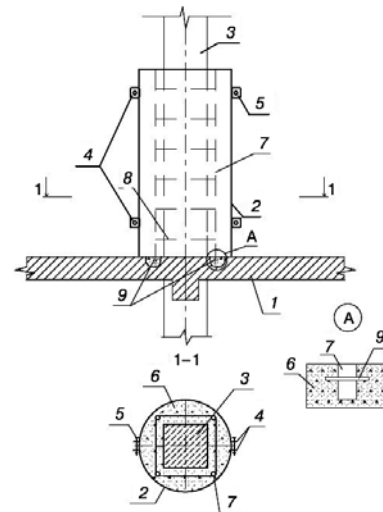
Усиление арматурным каркасом с применением анкеровки: 1 – плита перекрытия; 2 – U-образный металлический лоток; 3 – усиливаемая колонна; 4 – фланцы; 5 – болты; 6 – фибробетон; 7 – продольная арматура; 8 – поперечная арматура; 9 – стальная шайба
